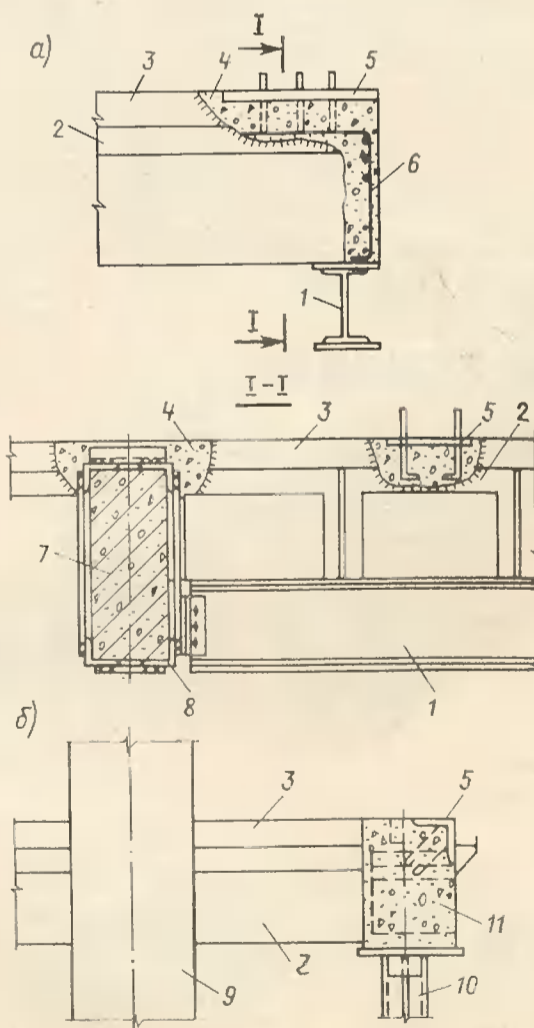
Крепление подвесного оборудования к стропильным фермам
